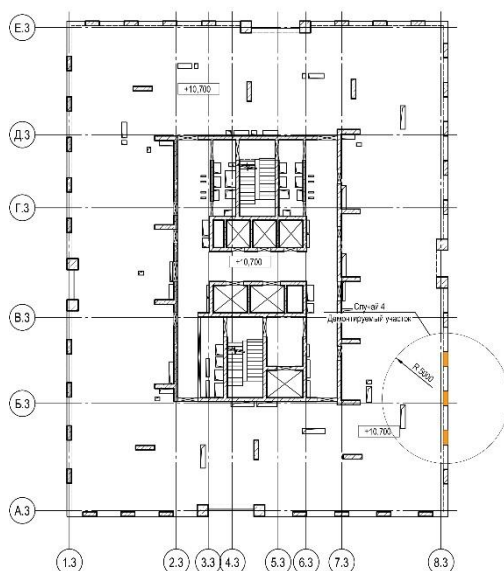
Корпус К-3. Схема аварийного случая 4
